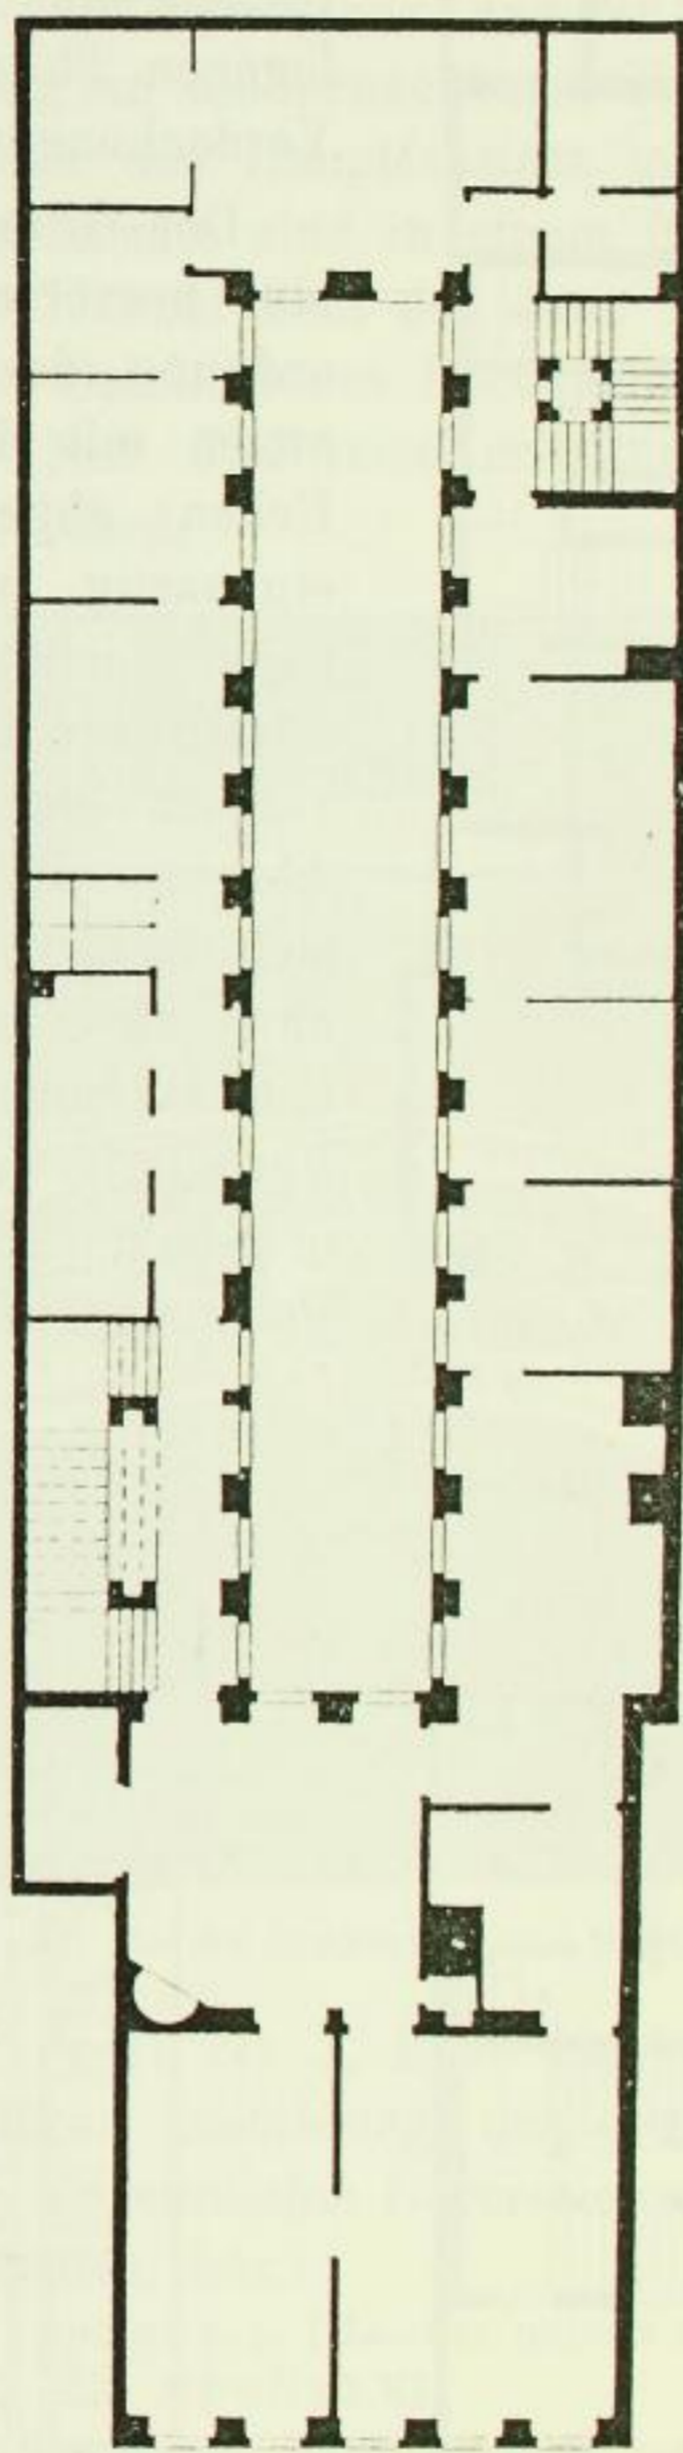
Breitstrasse Nr. 3. Grundriss.
